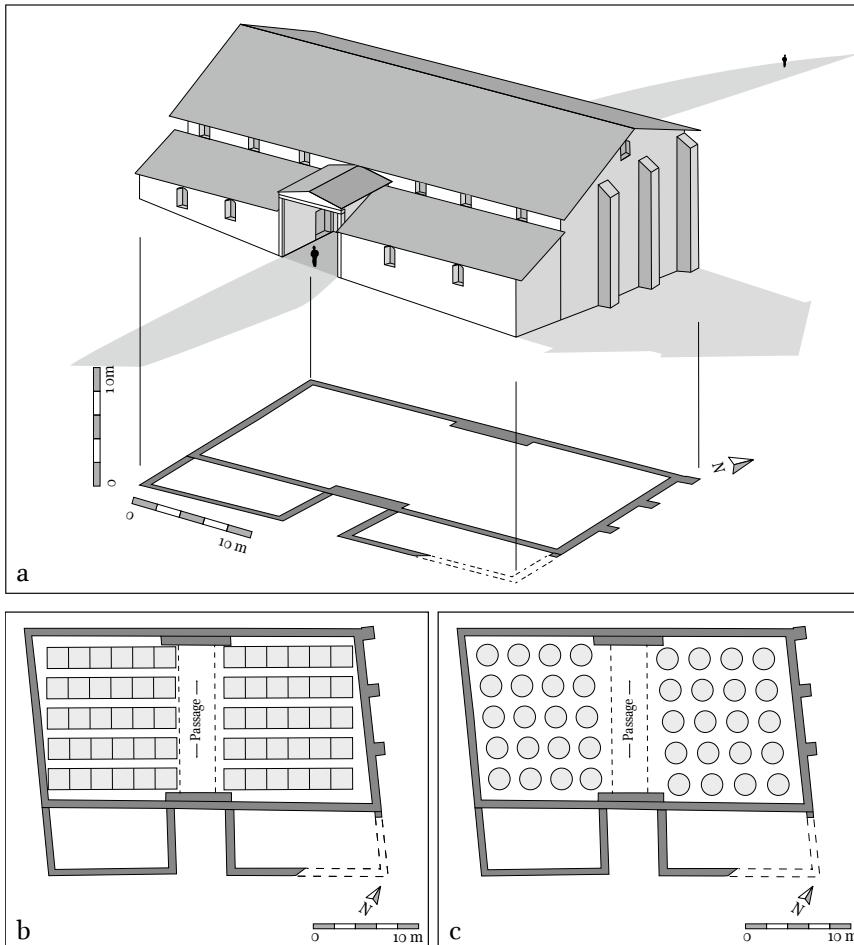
Le grand grenier à plancher surélevé sur piliers ou lambourdes à Alle :
